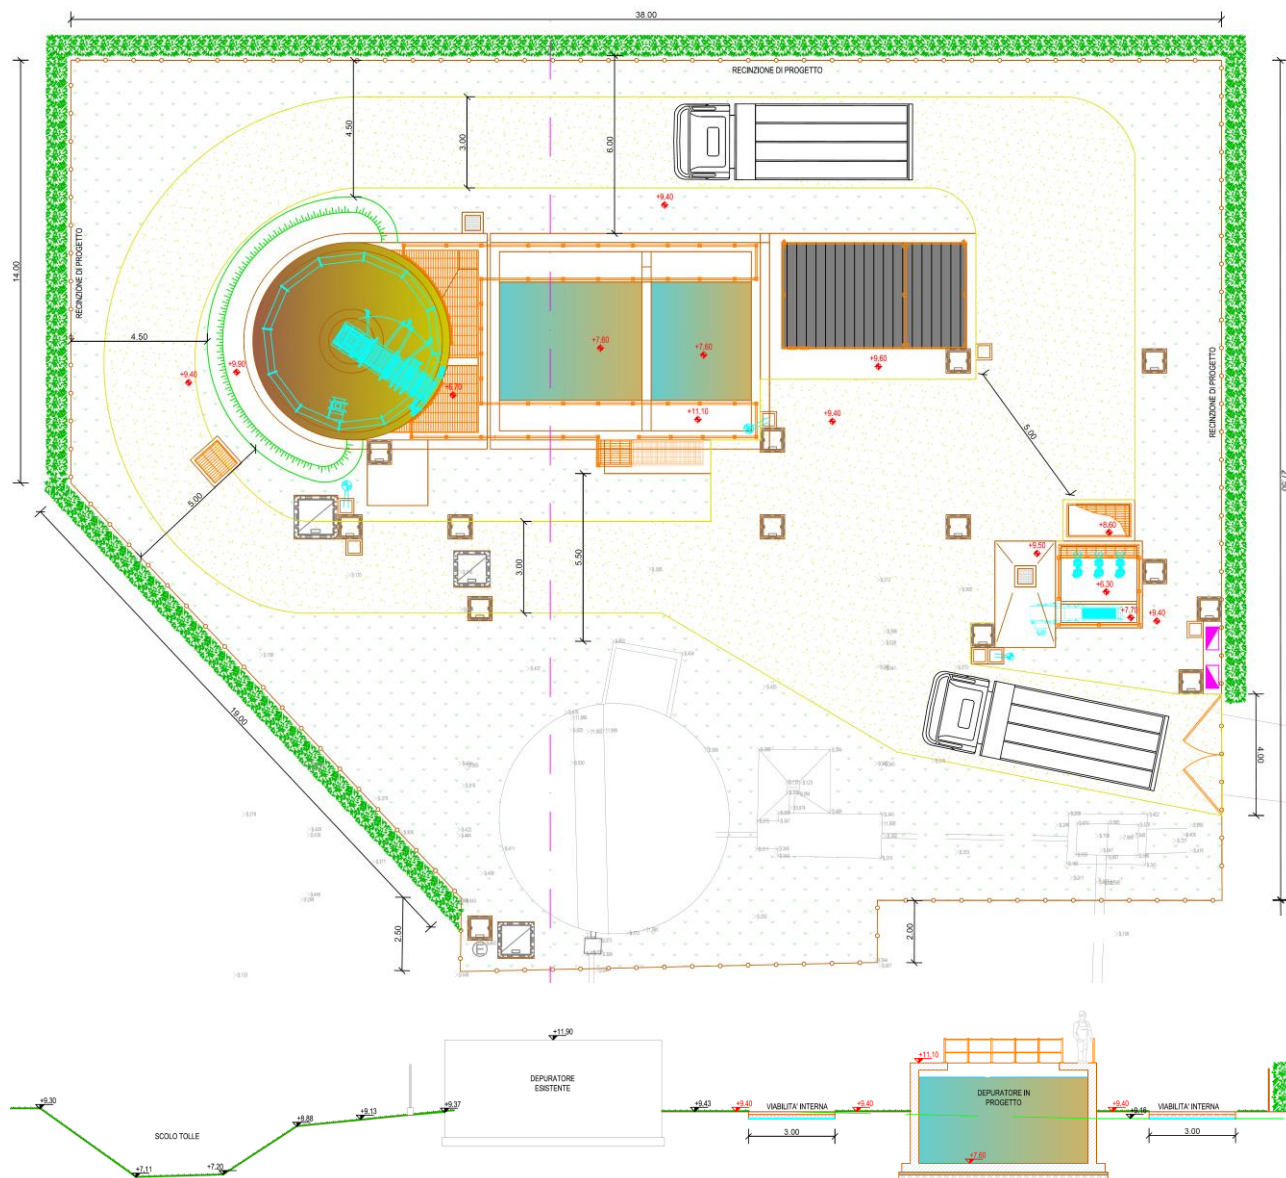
Planimetria e sezione trasversale di sistemazione dell'area esterna
